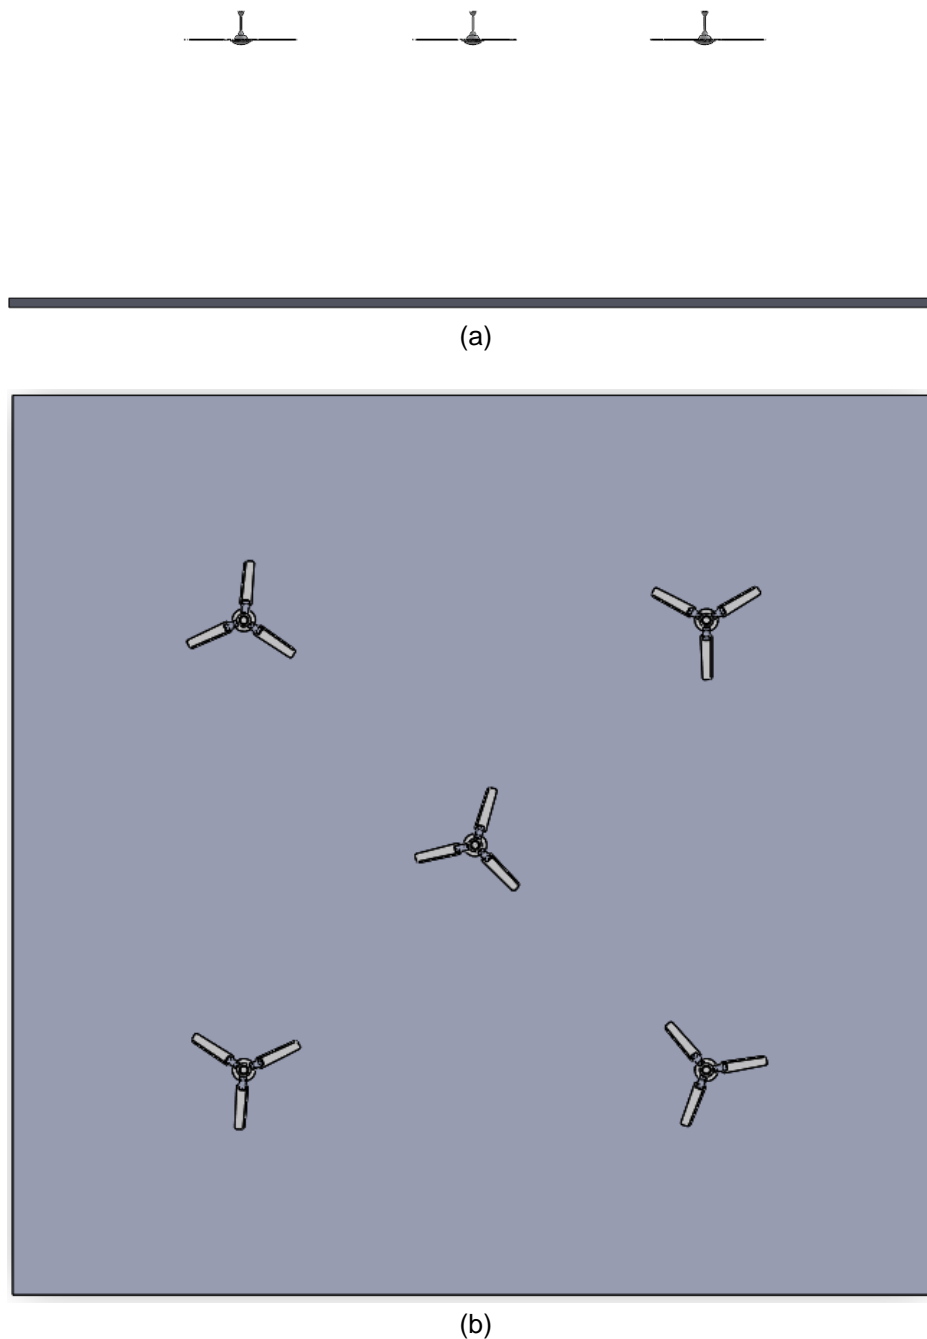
Vistas de la configuración con los ventiladores instalados en el techo: (a) alzado y (b) planta
